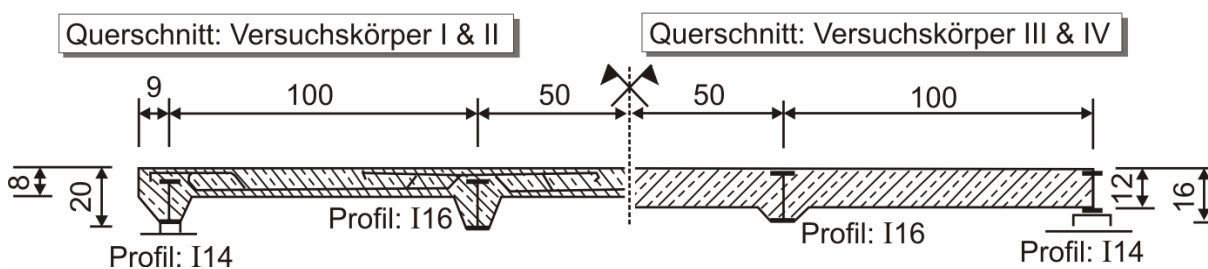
Schwingversuche mit Eisenbetondecken von GRÜNING 1937
